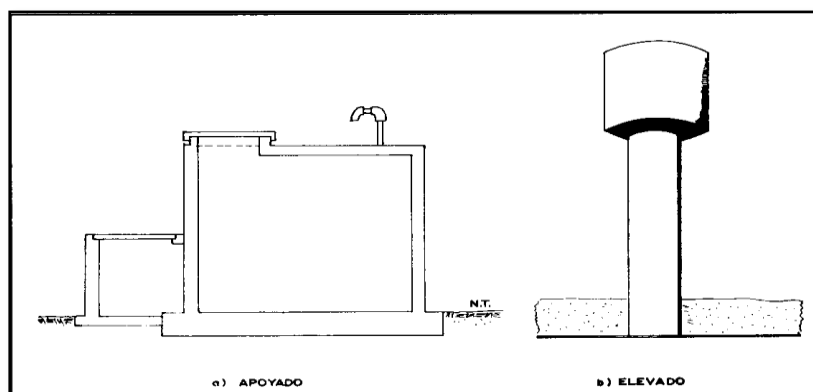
Tipos De Reservorio: Apoyado Y Elevado
